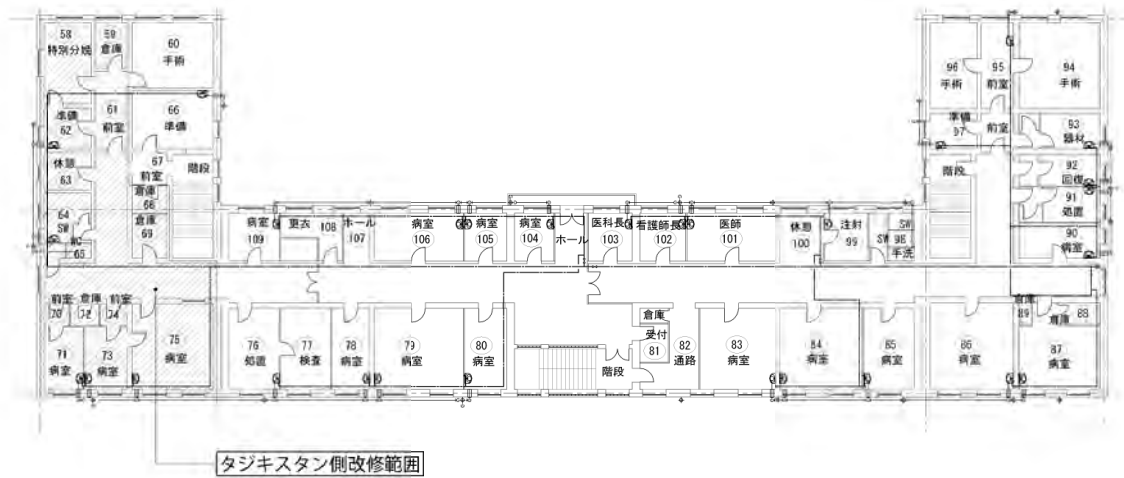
ショミ郡中央病院 産科棟 2F平面図 / 給排水計画図 1/300
